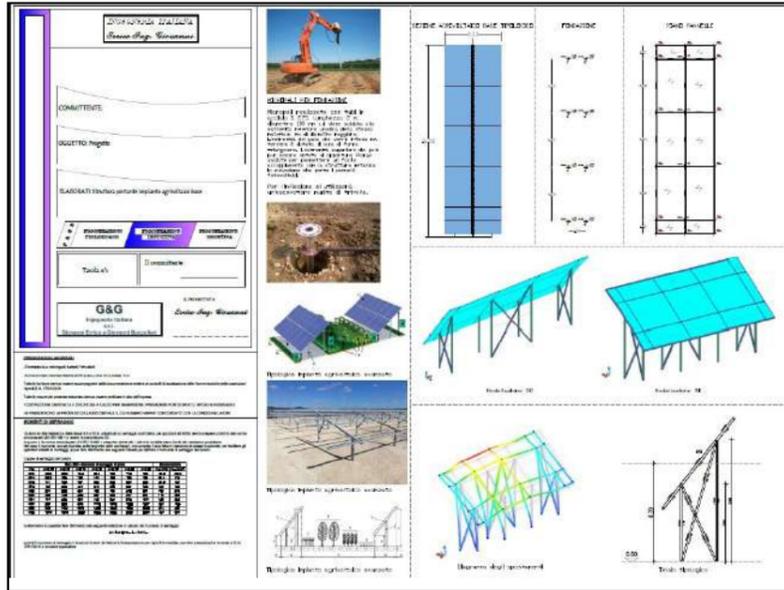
Progetto strutturale struttura FV di base. Tratto da Elaborati di Progetto
